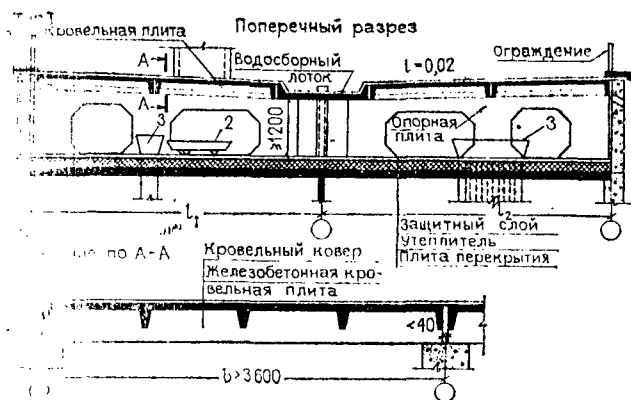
Чердачные сборные железобетонные крыши (покрытия)
